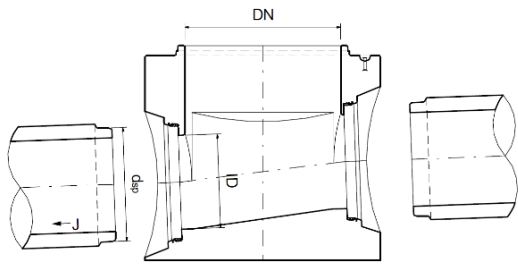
Anschluss mit CENTUB® Röser Stahlbetonrohre mit Gefälle  $J \leq 150 ‰$
